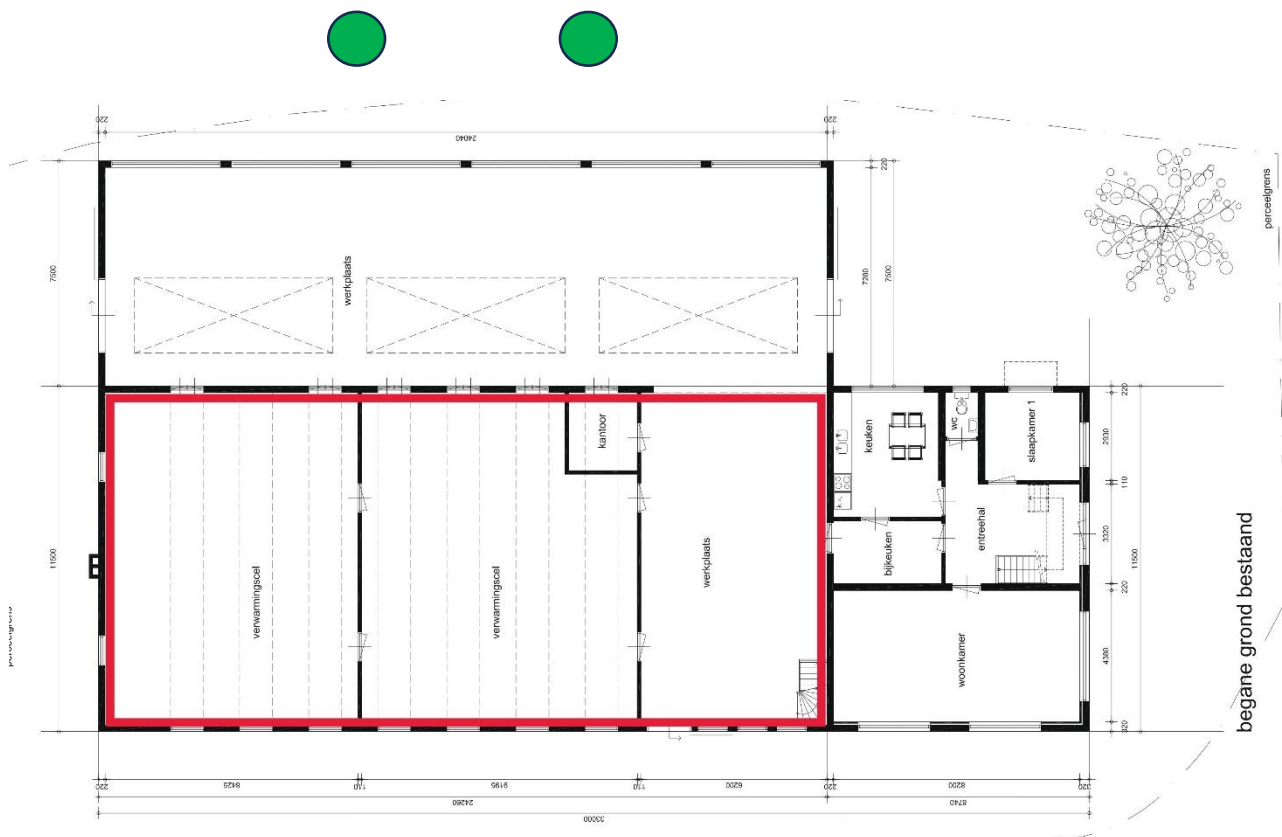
de oude bebouwde situatie(verstrekte informatie door klant). De bomen zijn aangegeven als groene stippen. Dit is geen vertegenwoordiging van hun daadwerkelijke beworteling of kroon.
